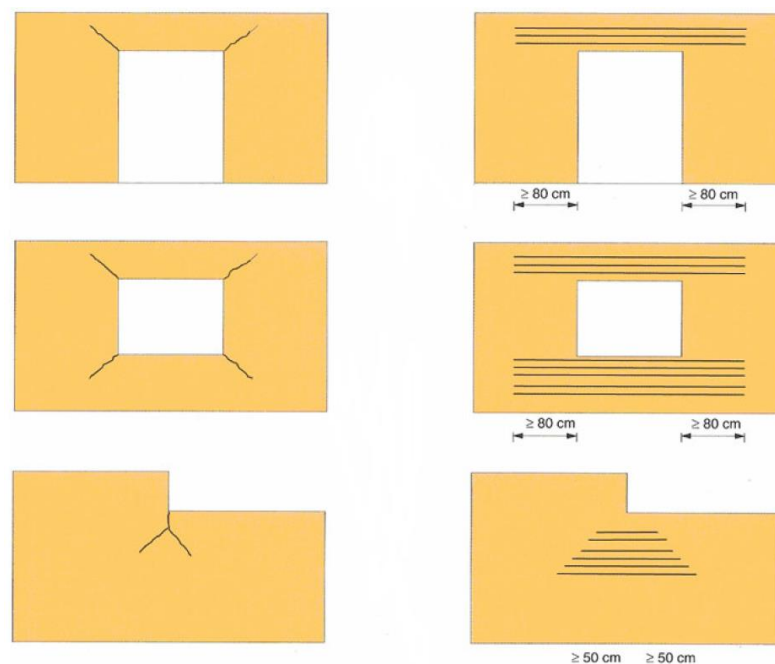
Zonas com maior probabilidade de sofrerem fissuração e disposição das respectivas armaduras [48]
